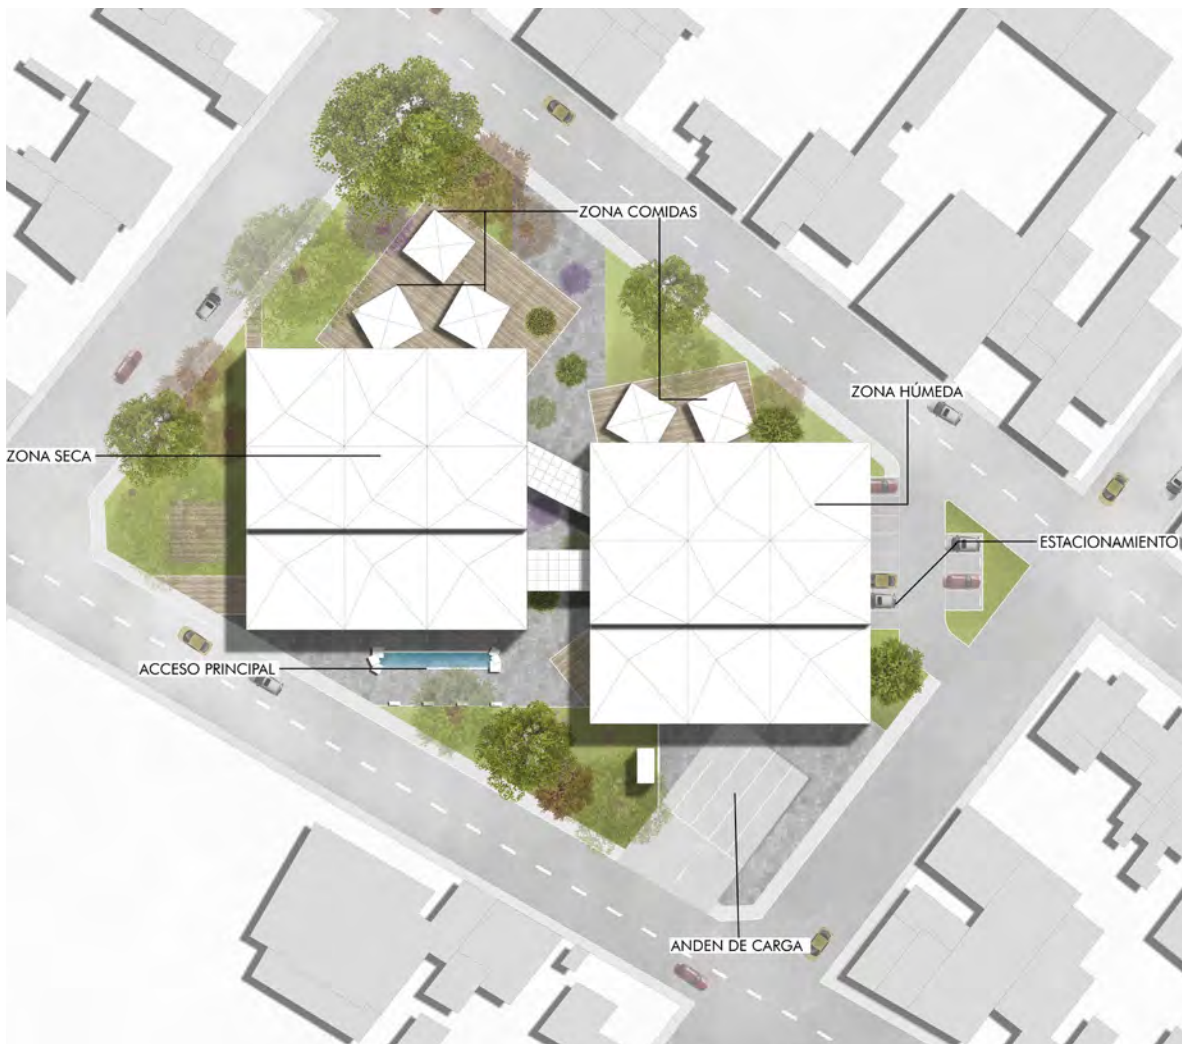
Planta de cubiertas. Imagen de elaboración propia.
